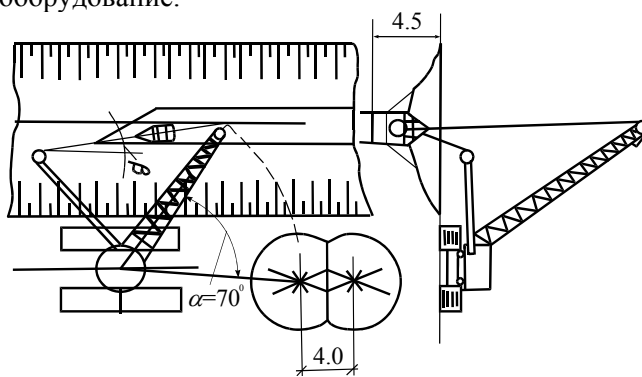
Схема работы экскаватора, оборудованного боковой стрелой
